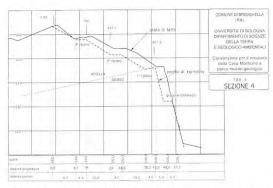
Esempio di sezione di progetto per ricavare una superficie sicura e fruibile (profilo di ripristino) rispetto alla parete di cava (stato di fatto). La sezione è ubicata in Fig. 15 (C. Elmi, G.B. Vai, 1988).
